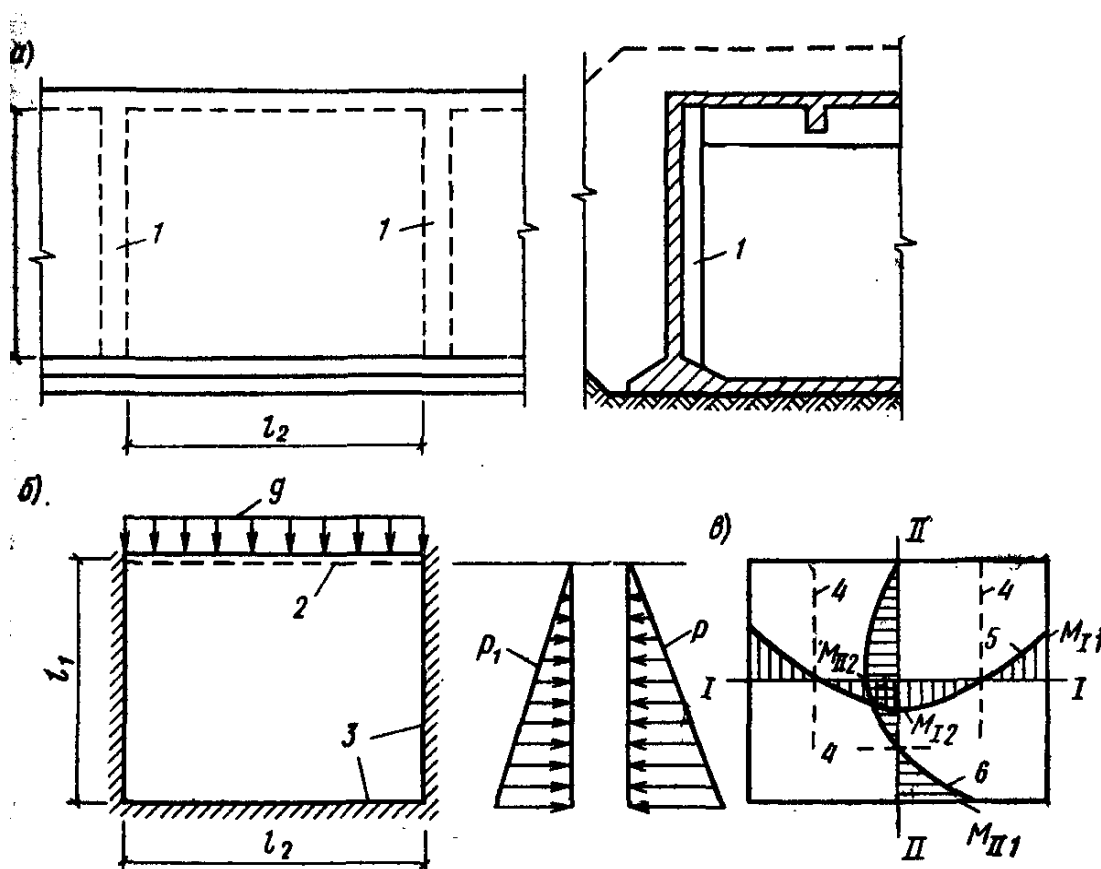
К расчету стены прямоугольного резервуара как плиты, опертой по контуру
